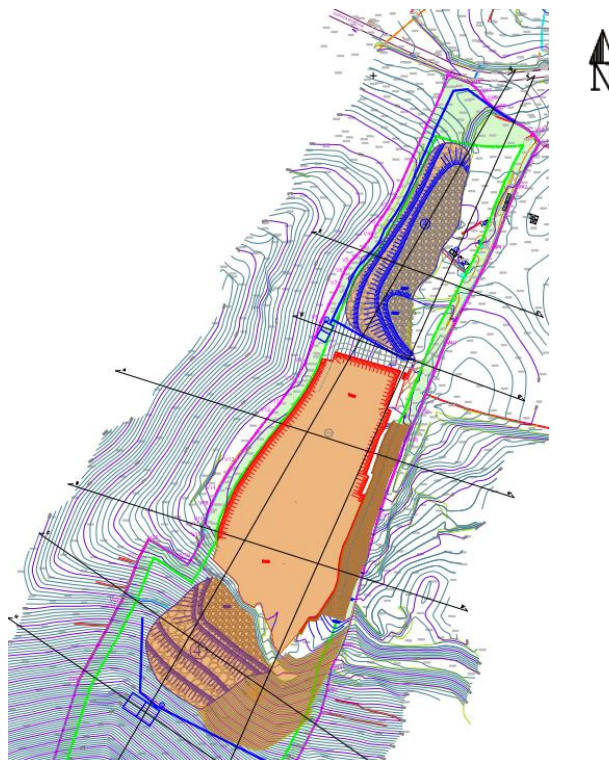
Planta de Modelação – Fase de desativação (ver também plantas em anexo).
